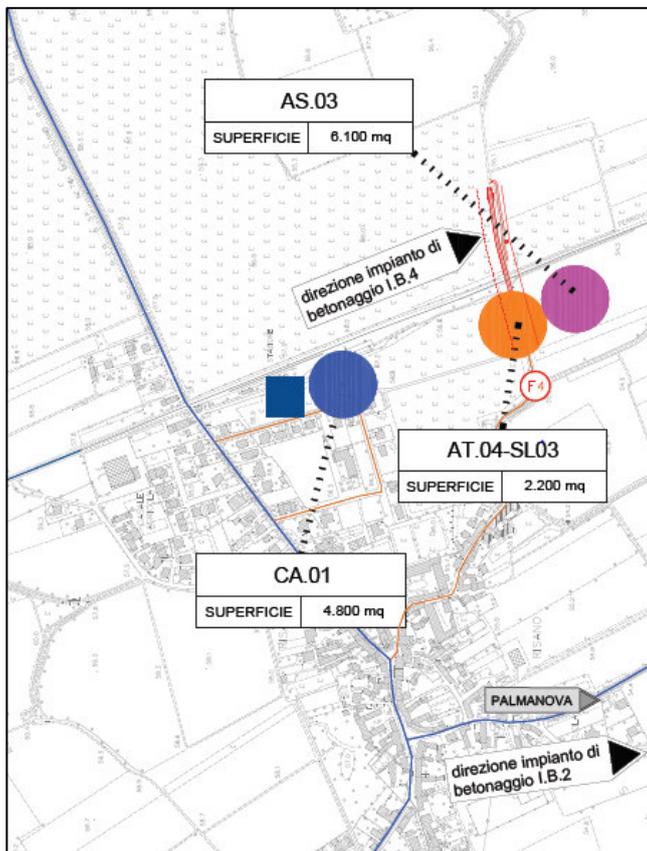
Aree di cantiere e viabilità di accesso 2/2
